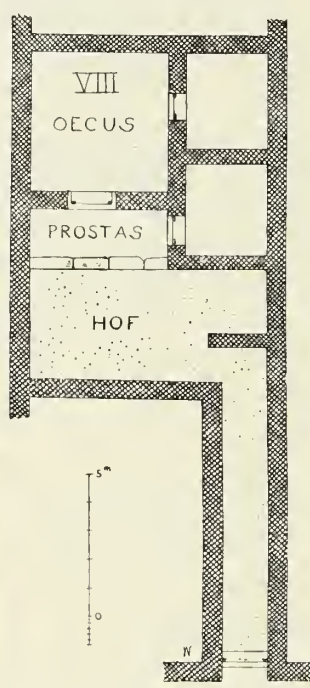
Grundriss des Hauses Nr. VIII.
